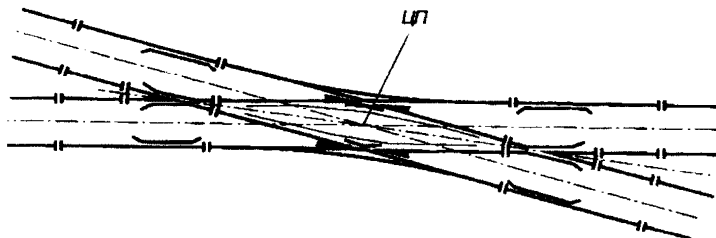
Схема перекрёстного стрелочного перевода.
